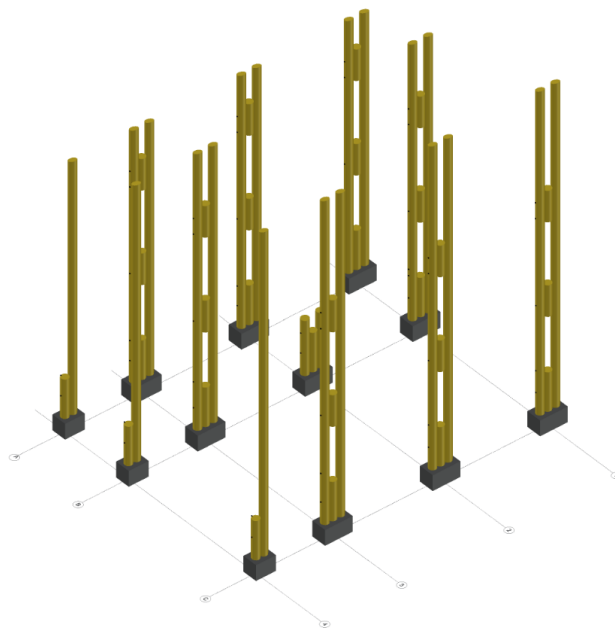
Columnas de la vivienda de emergencia. Fuente: Elaboración Propia
